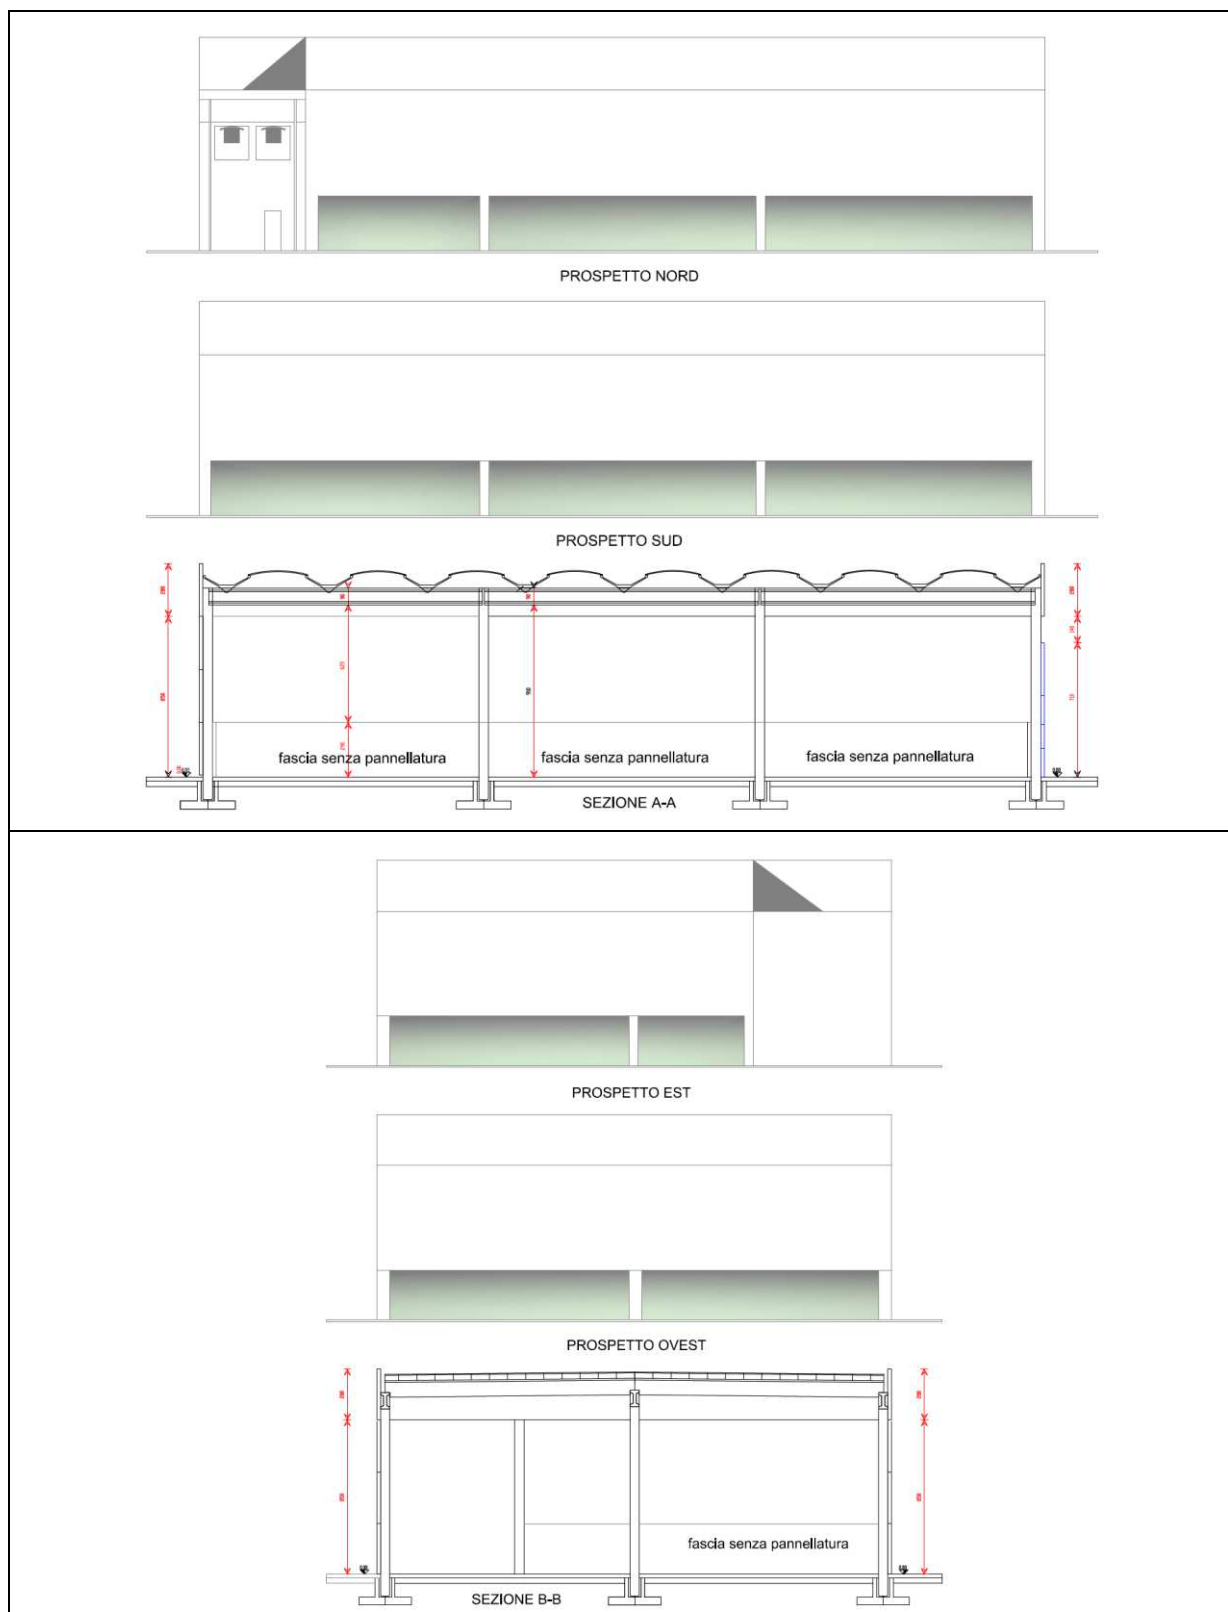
Prospetti e sezioni dell'edificio oggetto del presente Progetto in Variante.
